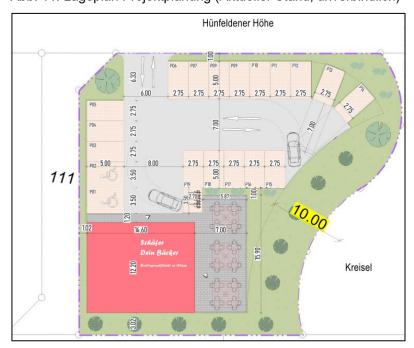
Lageplan Projektplanung (Aktueller Stand, unverbindlich)
